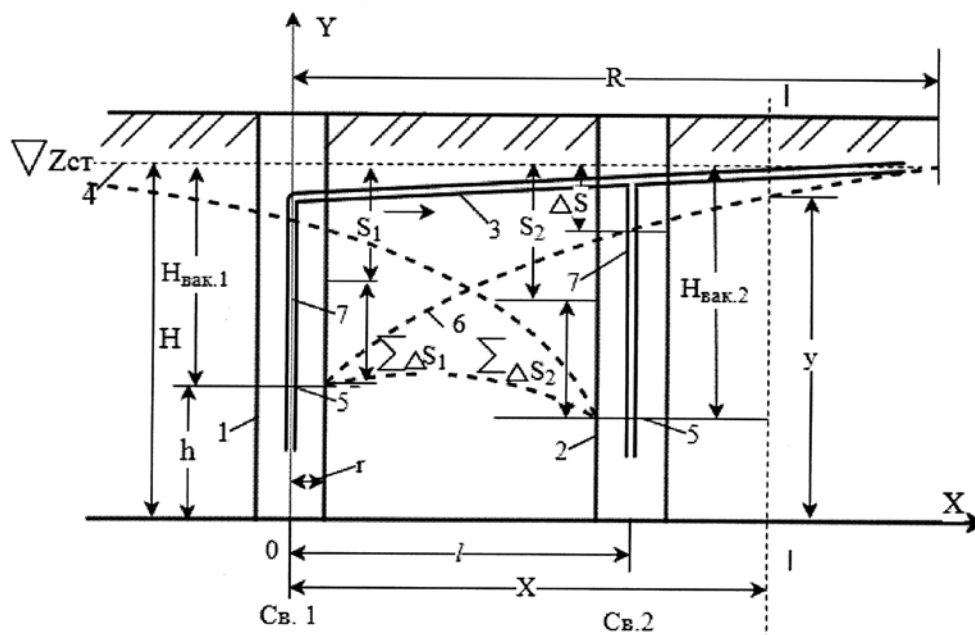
Розрахункова схема забору ґрунтових вод із безнапірного водоносного пласта взаємодіючими дренажними свердловинами з сифонним збірним водоводом:
